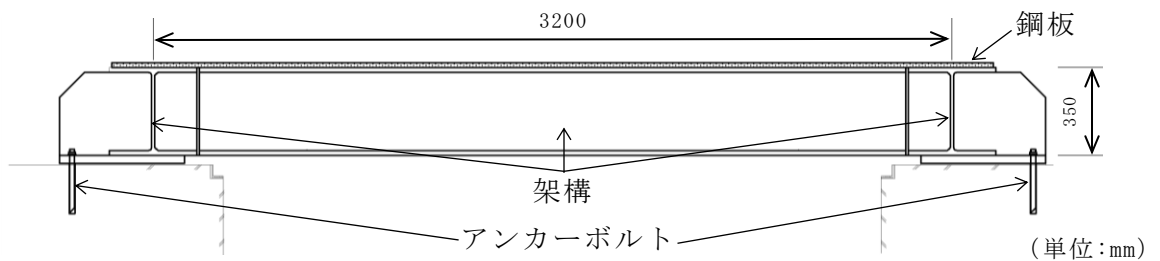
取水槽循環水ポンプエリア防護対策設備の概略断面図 (A-A 断面)
